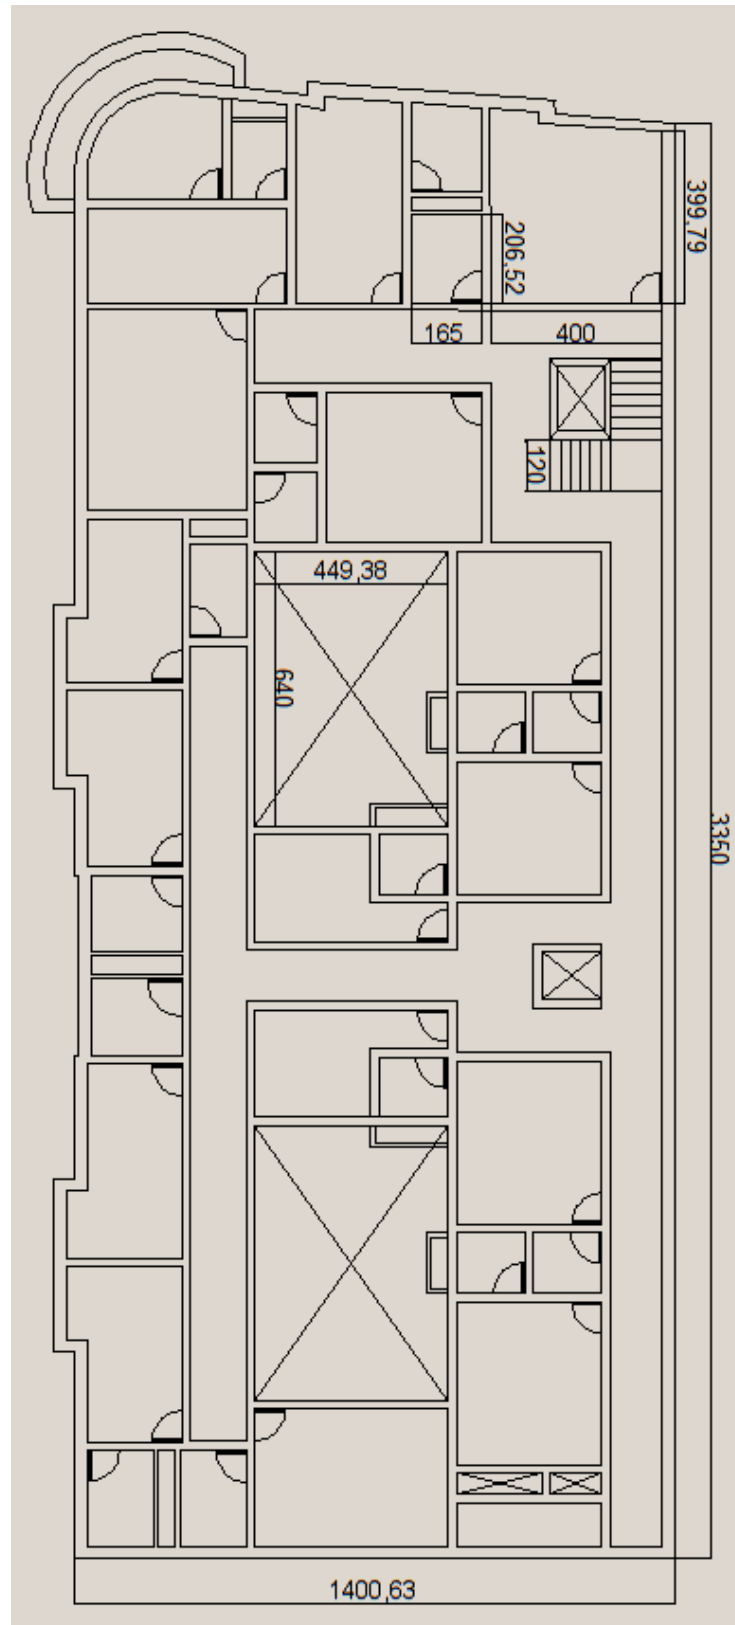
Esboço do pavimento tipo (primeiro andar) do edifício
